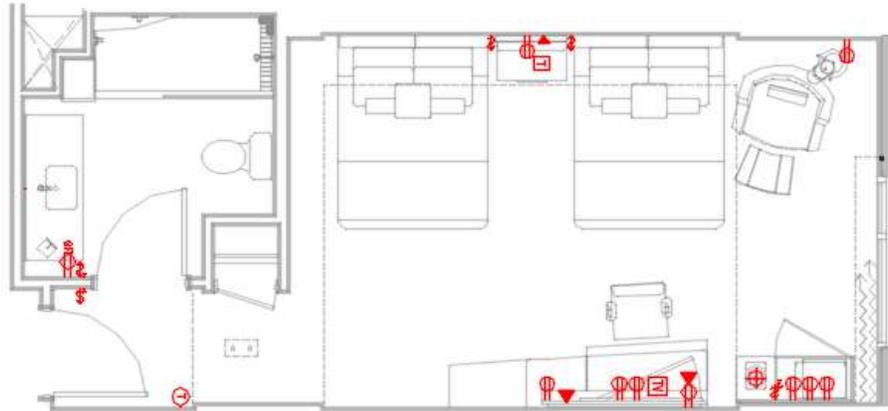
Planta de Fuerzas Habitación Doble Queen
